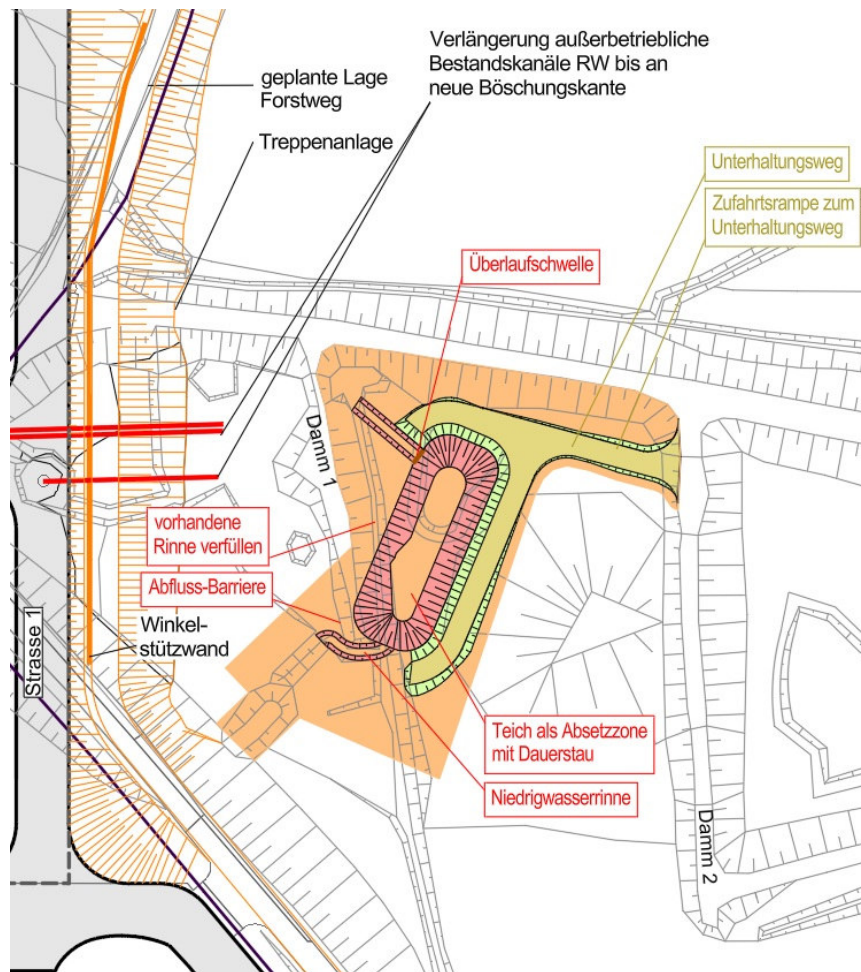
Flächenbedarf (Quelle: Lageplan – Regenrückhaltebecken).
